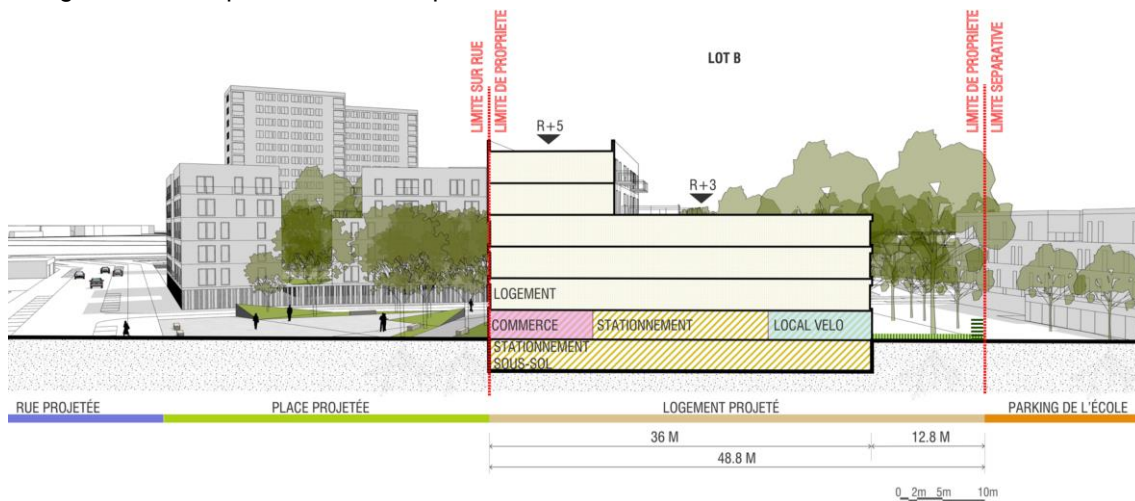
Plan de coupe du lot B dans son environnement urbain (La Fabrique Urbaine, 01/2024)
